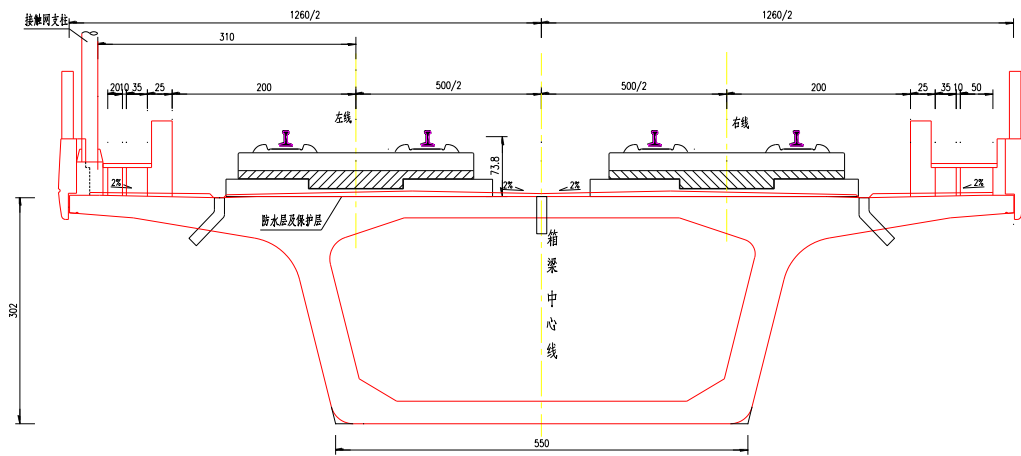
高铁桥面布置示意图 (线间距 5.0m)
